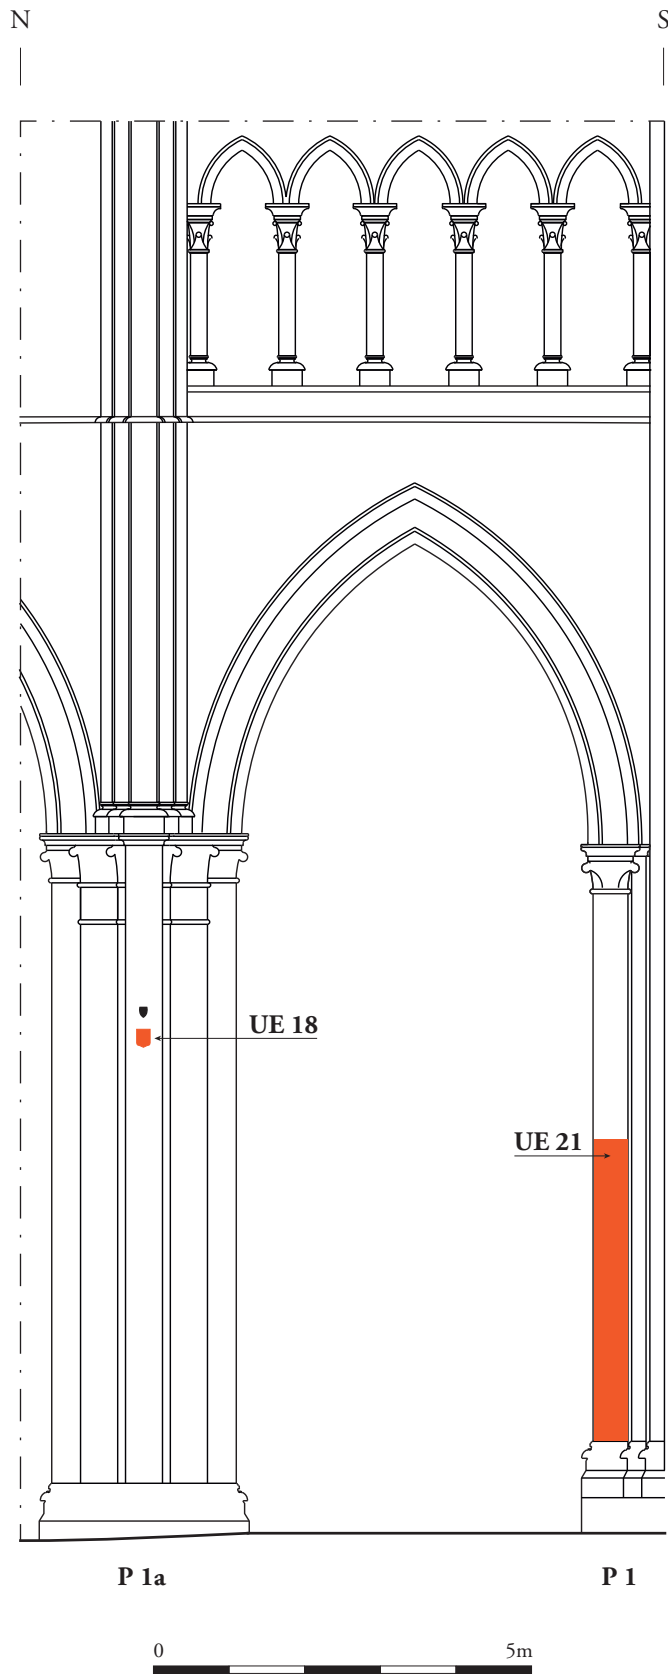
Élévation OUEST des piliers P 1 et P 1a, localisation des décors peints (UE 18 et UE 21) – échelle : 1/100.
